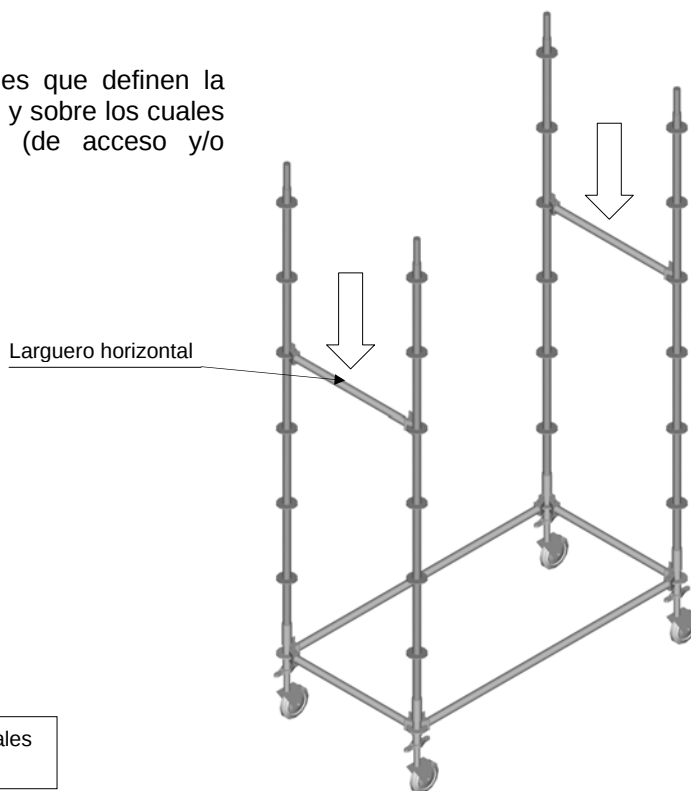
Montaje de largueros horizontales para la anchura de la torre.
